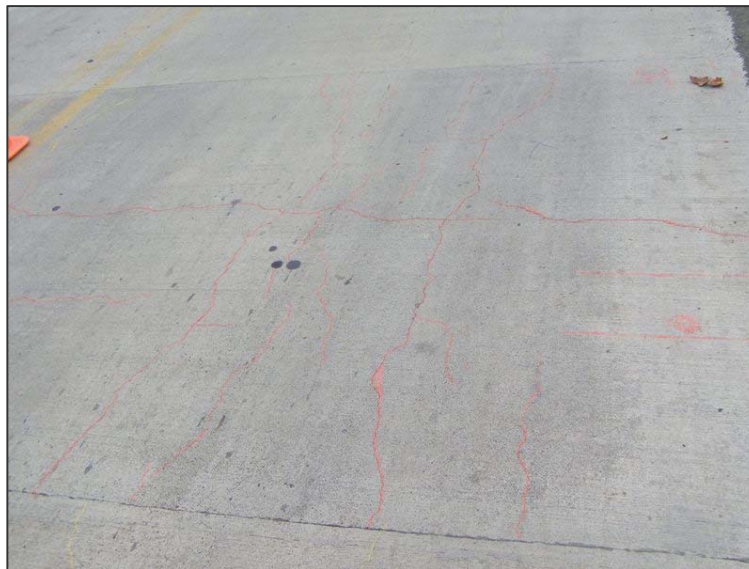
Agrietamiento de la losa (sección 3 D)
